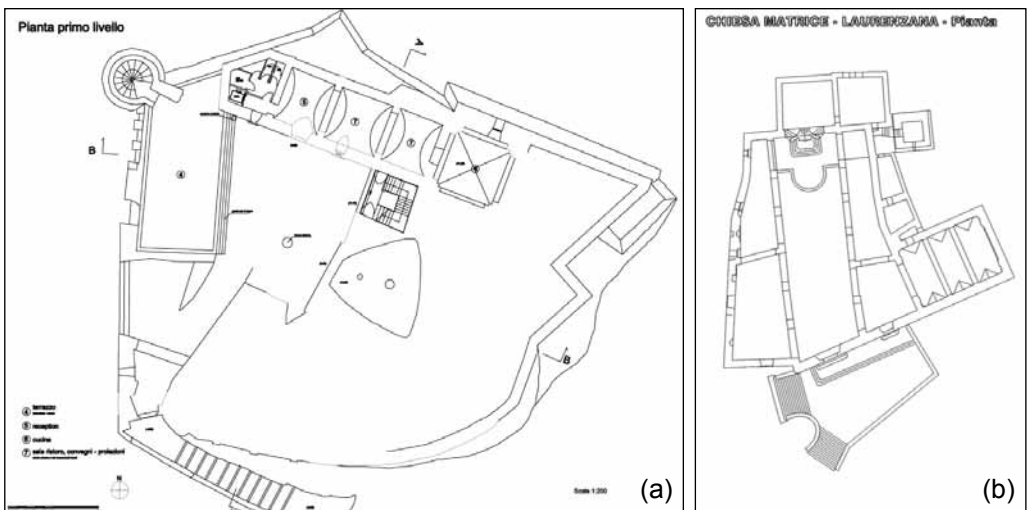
Planimetria del castello (a) e della chiesa Madre (b).
